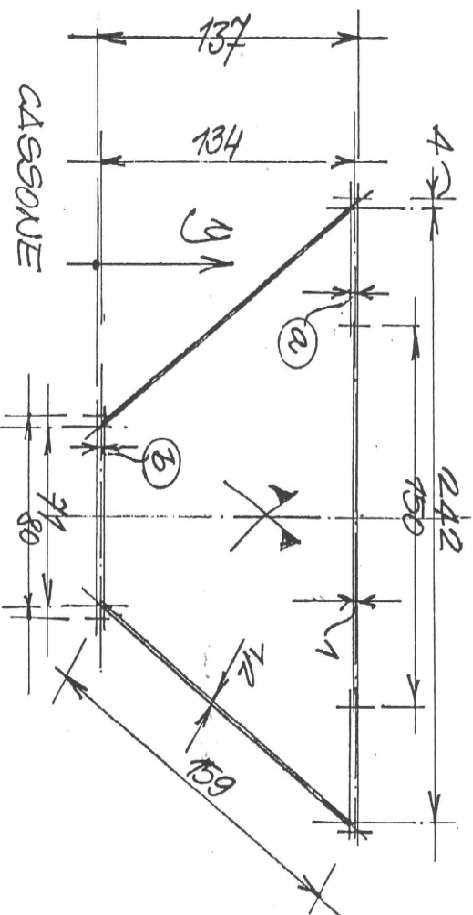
Trave a Cassone presente sopra ai pilastri del portico
